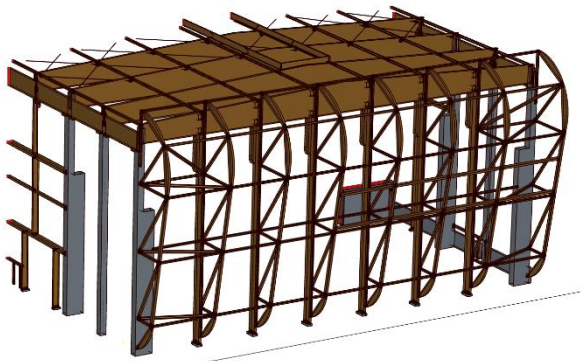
Isometrie gerundete Fassade Kaltwalze
